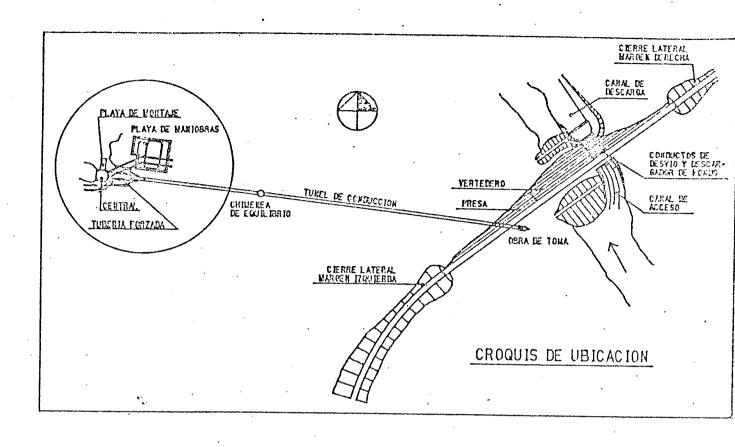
PLANO GERAL DE ESTRUTURAS
